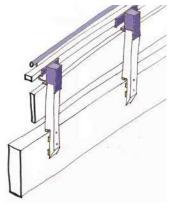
Pudrición de la jácena principal en contacto con los montantes de la barandilla.
